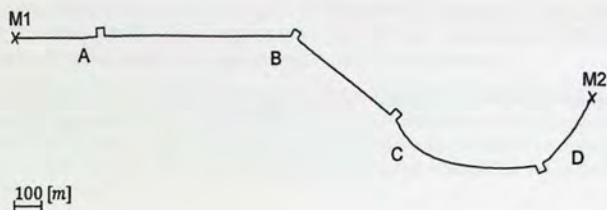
Ubicación de zonas de esfuerzos relevantes, cañería con juntas de expansión.
